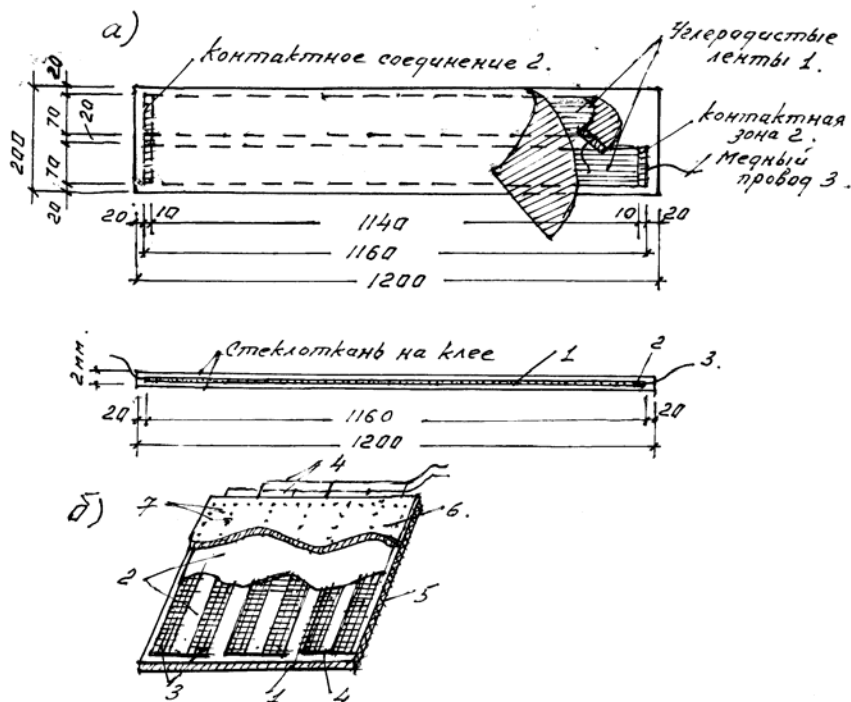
Схема греющего элемента на основе углеродистых лент (а) и схема собранного опалубочного щита (б):
